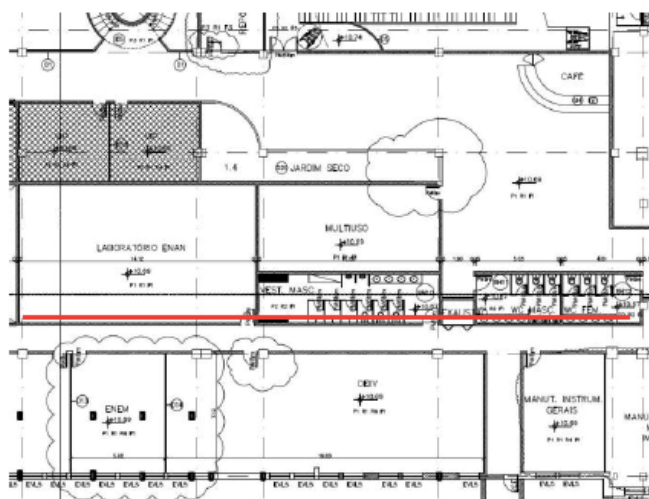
Planta baixa com detalhe do cabo irradiante.
